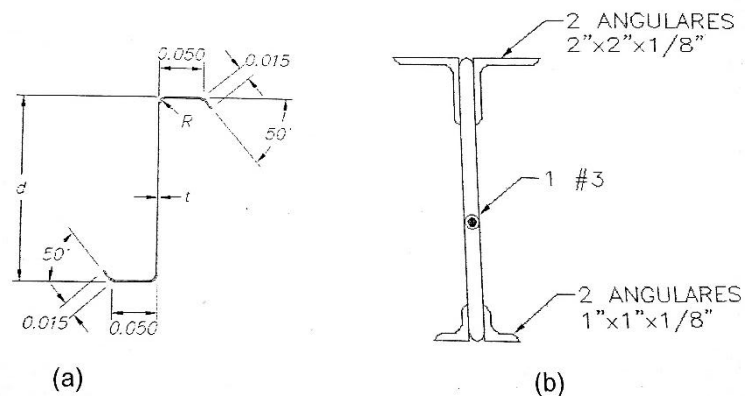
Larguero de acero para techos. (a) larguero compuesto por un perfil de sección Z. (b) Larguero de alma abierta, compuesto por angulares y varillas.
